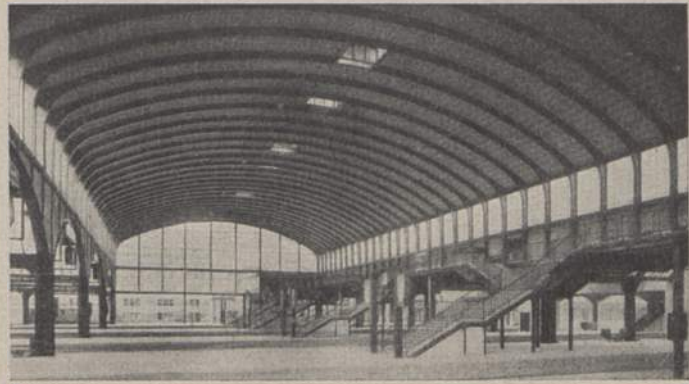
Bahnsteighalle Bahnhof Darmstadt.
